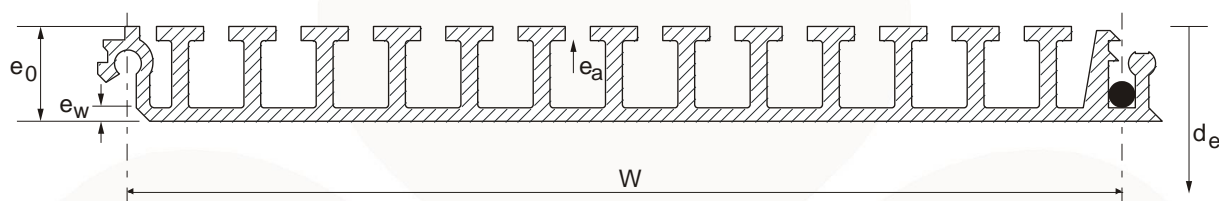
a - Exemple de section transversale d'un profilé PVC pour enroulement hélicoïdal
